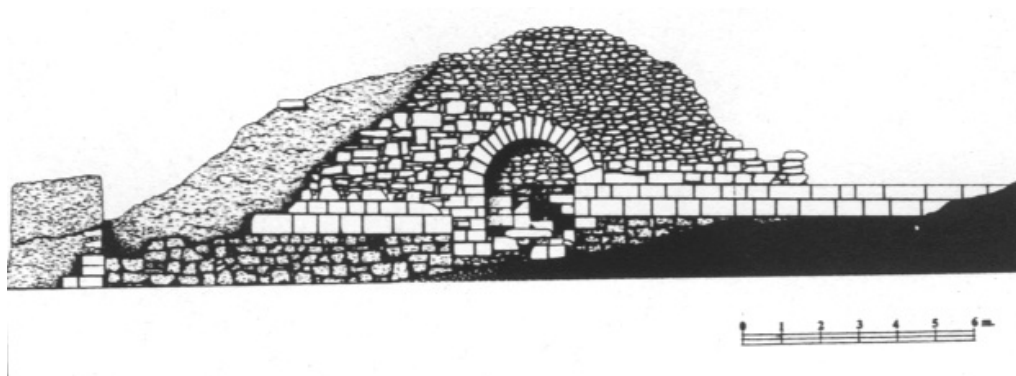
Conjunto de El Burgo. Alzado de la manguardia con “exedra”
